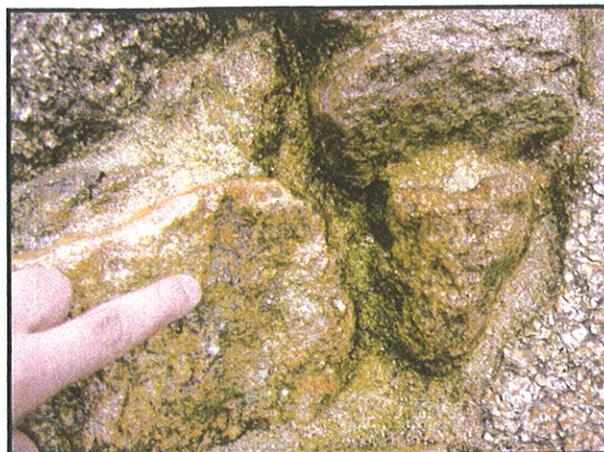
Primer grado de manchado en mortero sin color. Aplicado en 2005 y vista en la actualidad.
